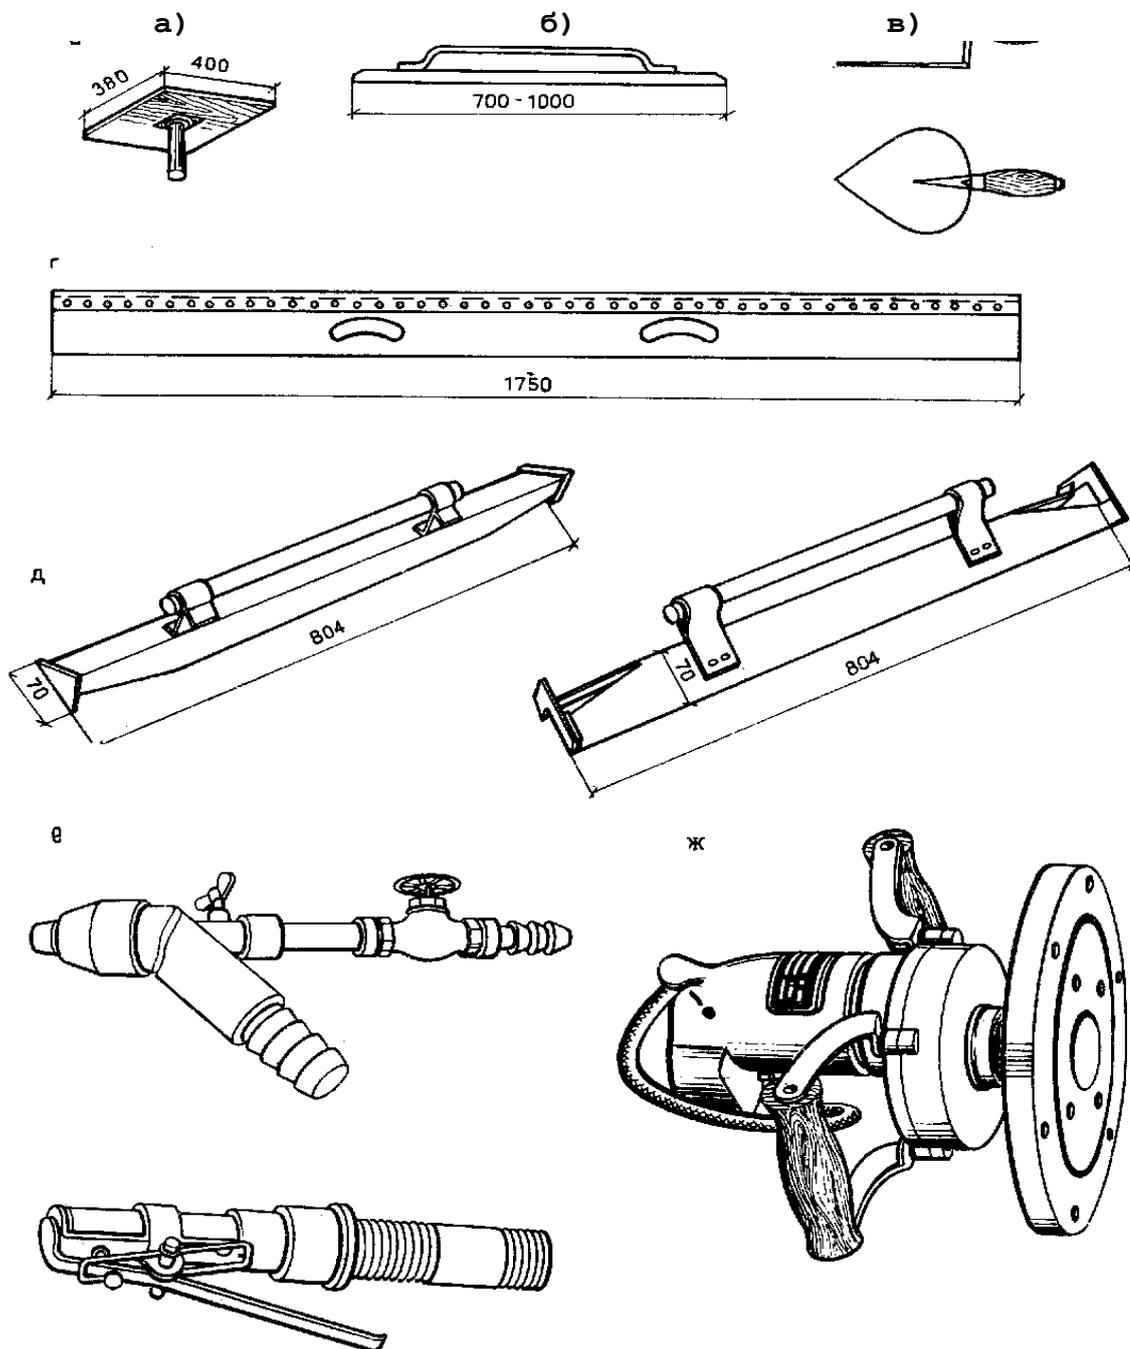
Основной инструмент и ручные машины для выполнения обычных штукатурок : а - сокол; б - полутёрком; в - мастерок; г - правило; д - лузговое и усеночное правило; е - форсунки пневматического и бескомпрессорного распыления; ж - затирочная ручная машина
